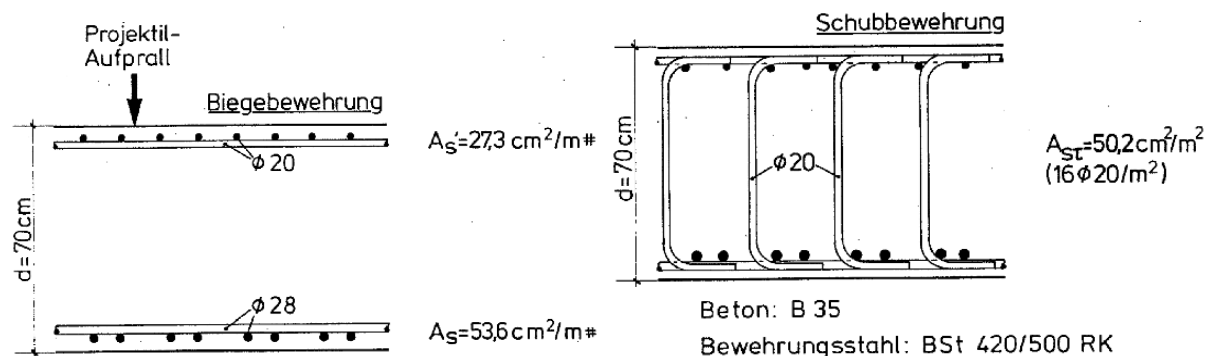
Disposition des armatures longitudinales (à gauche) et transversales (à droite).
